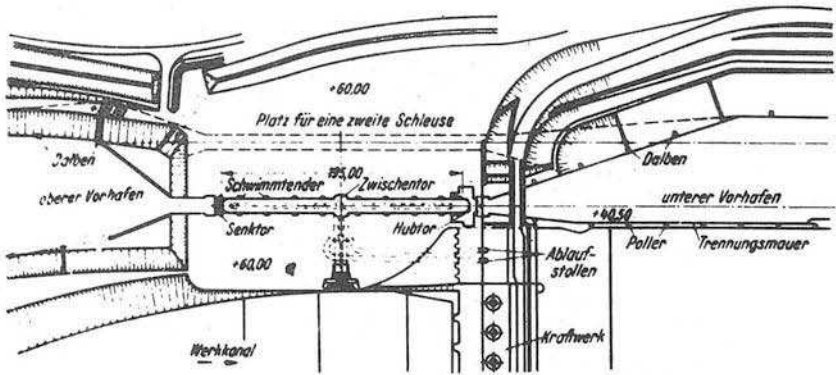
Schleuse Saint Pierre der Rhône-Staustufe Donzère-Mondragon (Lageplan)
